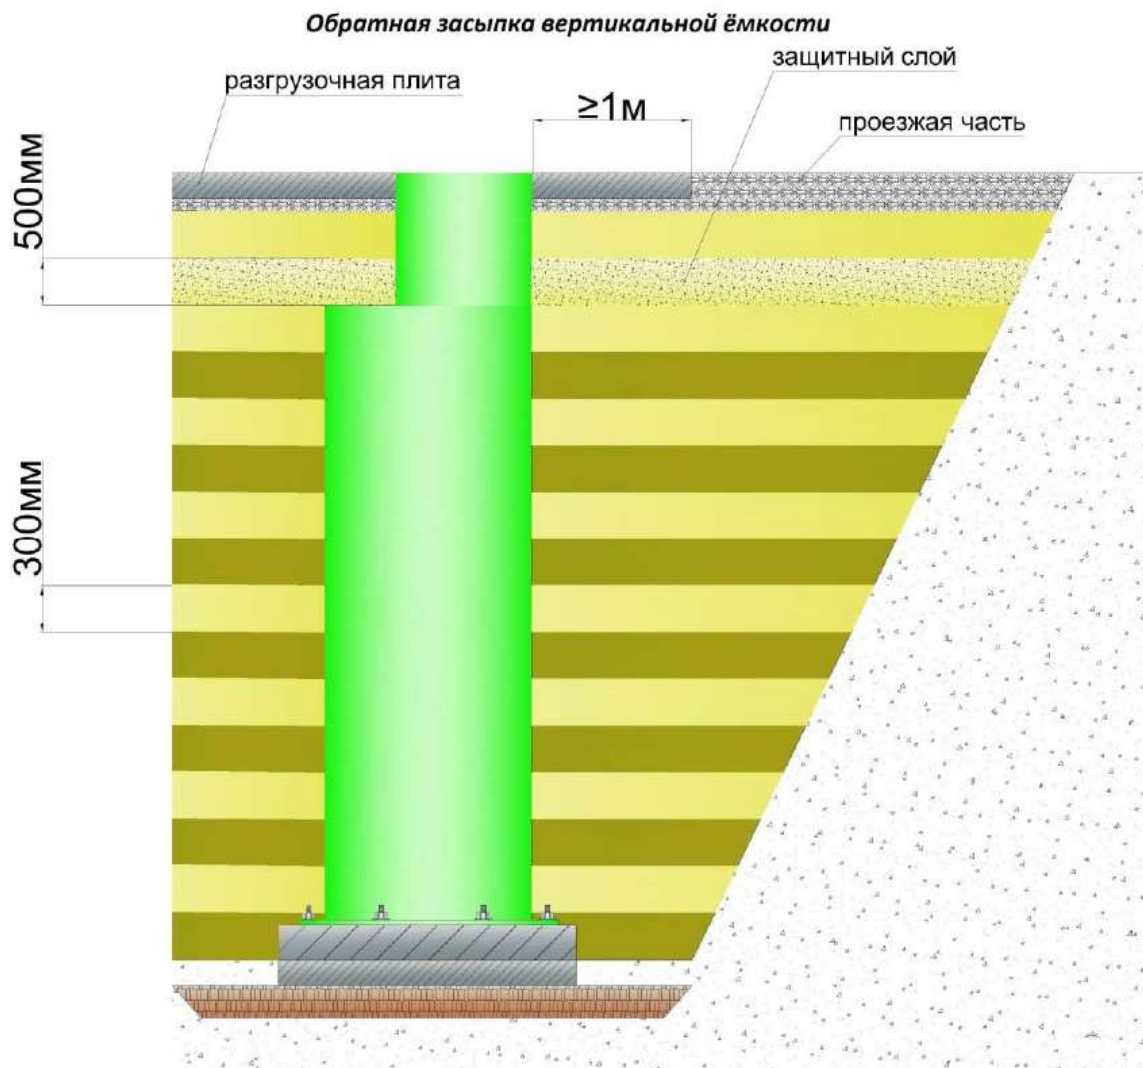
схема обратной засыпки корпуса с разгрузочной плитой
